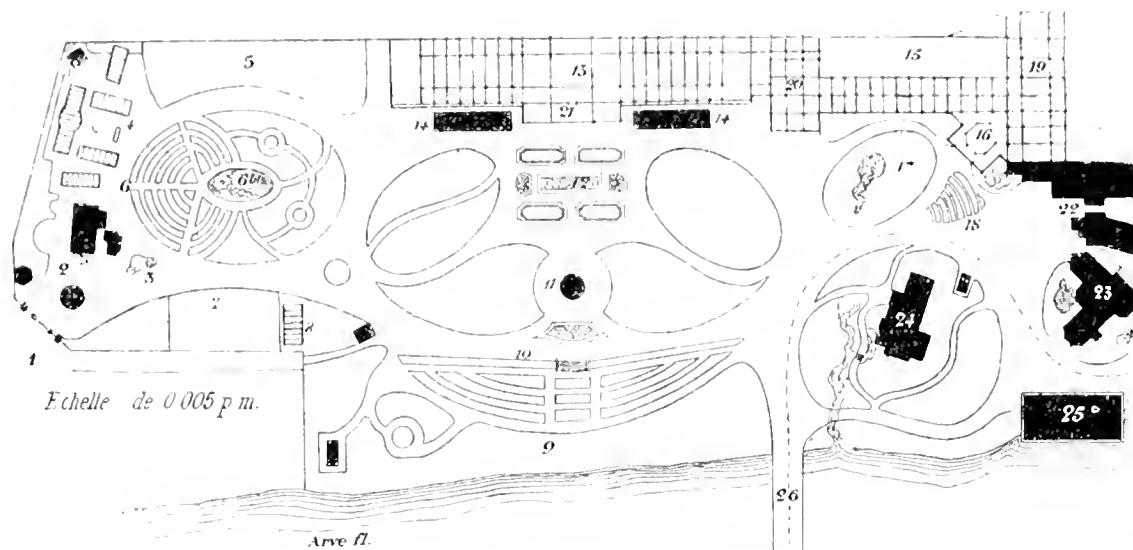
Plan de la Section horticole à l'Exposition de Genève
